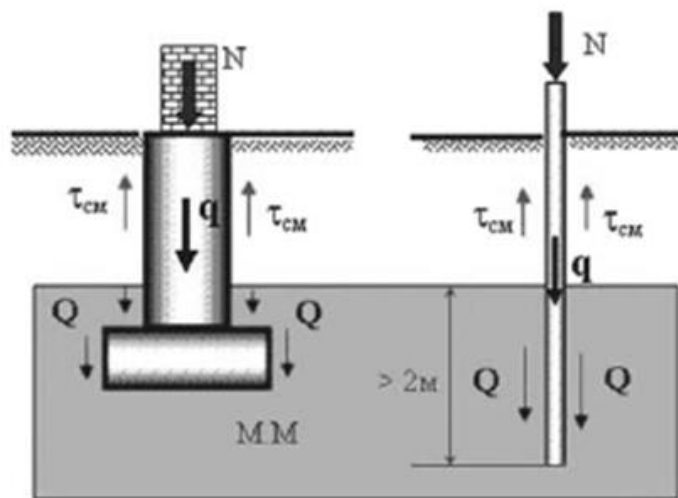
Расчетная схема устойчивости отдельно стоящих и свайных фундаментов в вечномерзлом слое грунта
